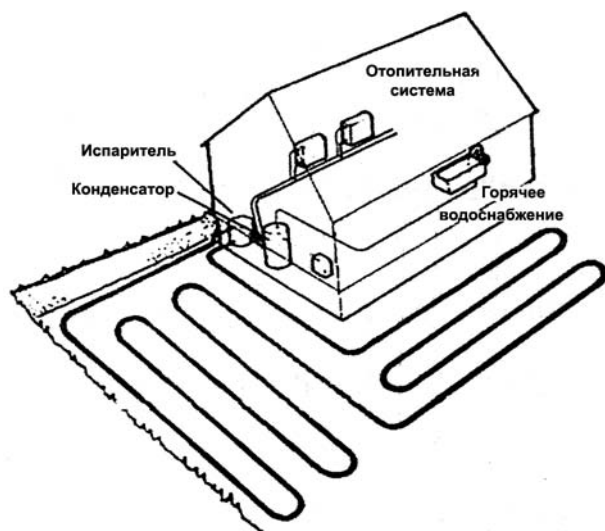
Схема теплового насоса, работающего на грунтовом источнике теплоты.
